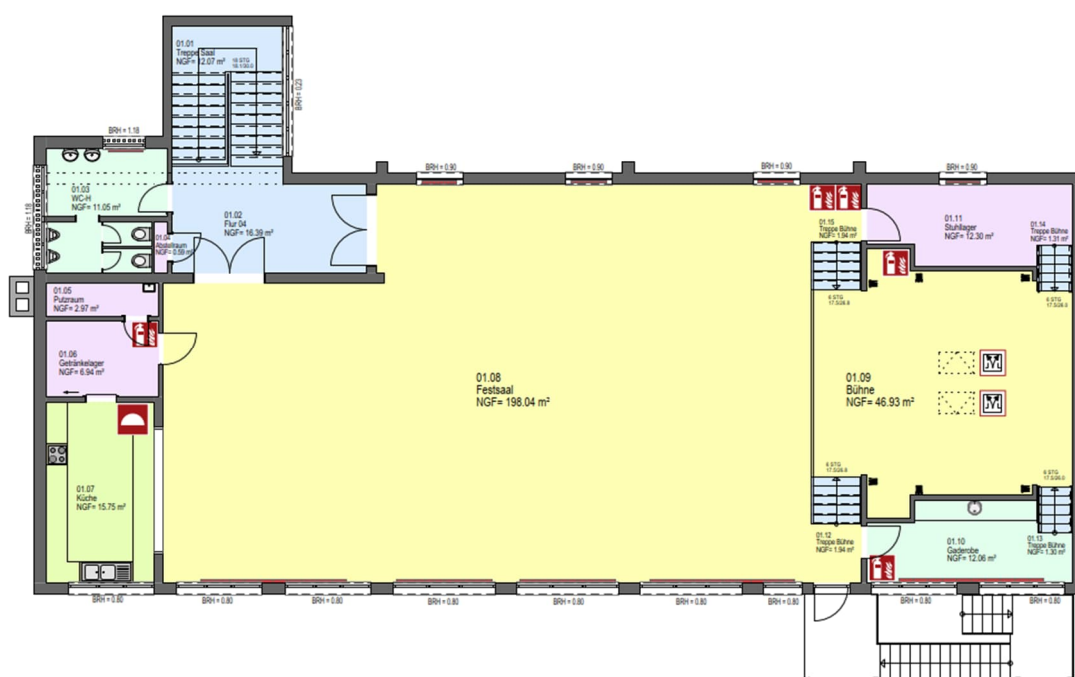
Übersicht Grundriss Obergeschoss Bestand
